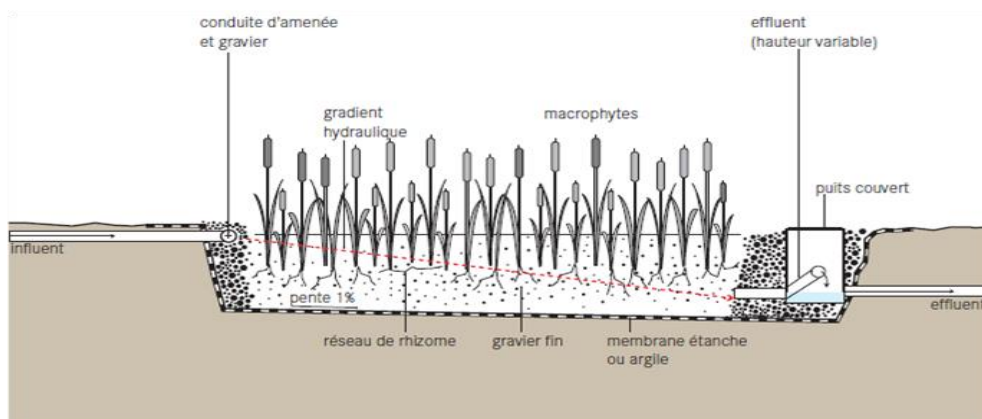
coupe transversale d'un filtre planté horizontal à écoulement sous-surface.
